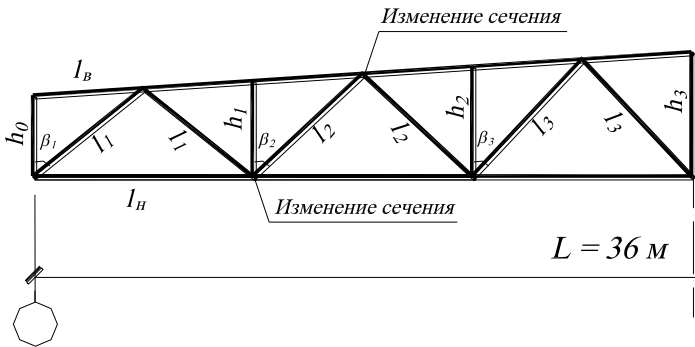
Геометрические схемы для расчета стропильных ферм промышленных зданий
